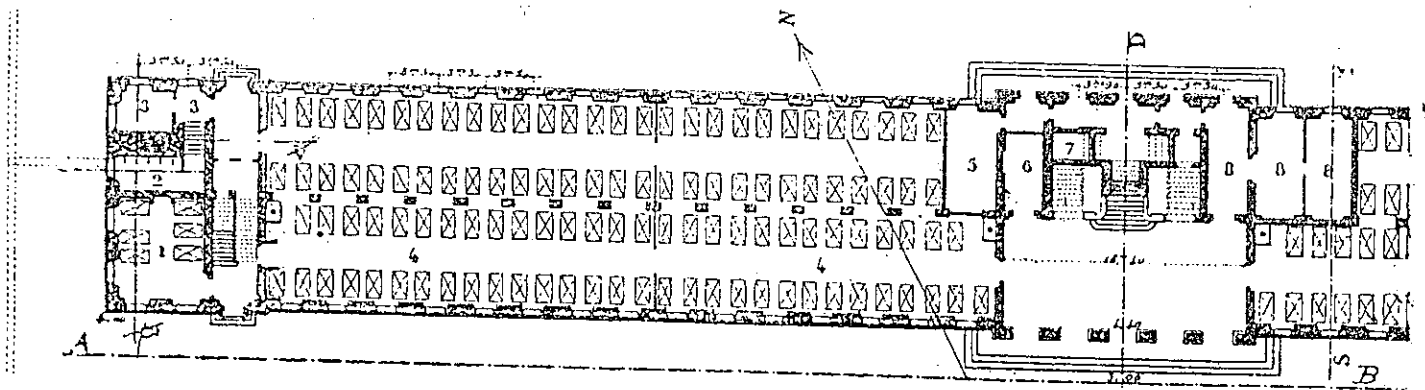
Plan du rez-de-chaussée. — Échelle de 0,002 p. 1 ($\frac{1}{500}$).
